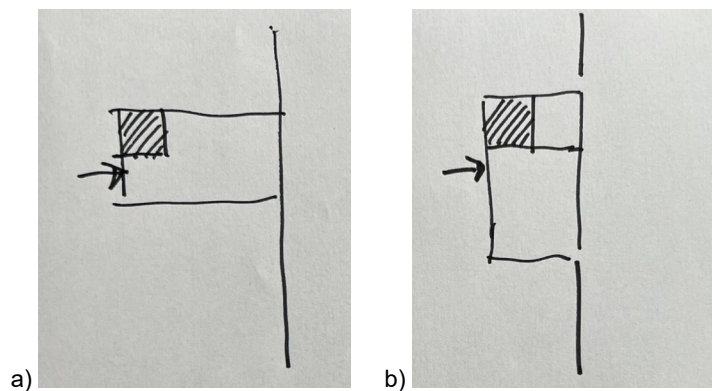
Skizzen mit Zimmerlayouts. a) Klassisches Zimmerlayout mit längsrechteckigem Raum und kurzer Fassadenfläche (Nasszelle schraffiert); b) Querliegendes Zimmerlayout als Ergänzung zum klassischen Layout in weniger tiefen Gebäudeteilen (Nasszelle schraffiert).
